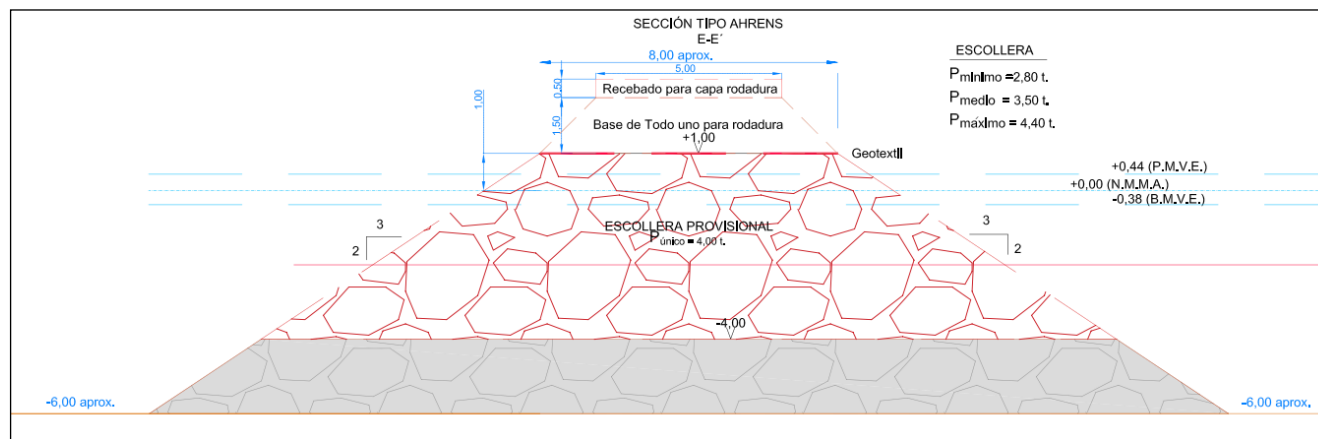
Sección tipo espigón en tramo sumergido, con obra provisional de acceso para ejecución.
